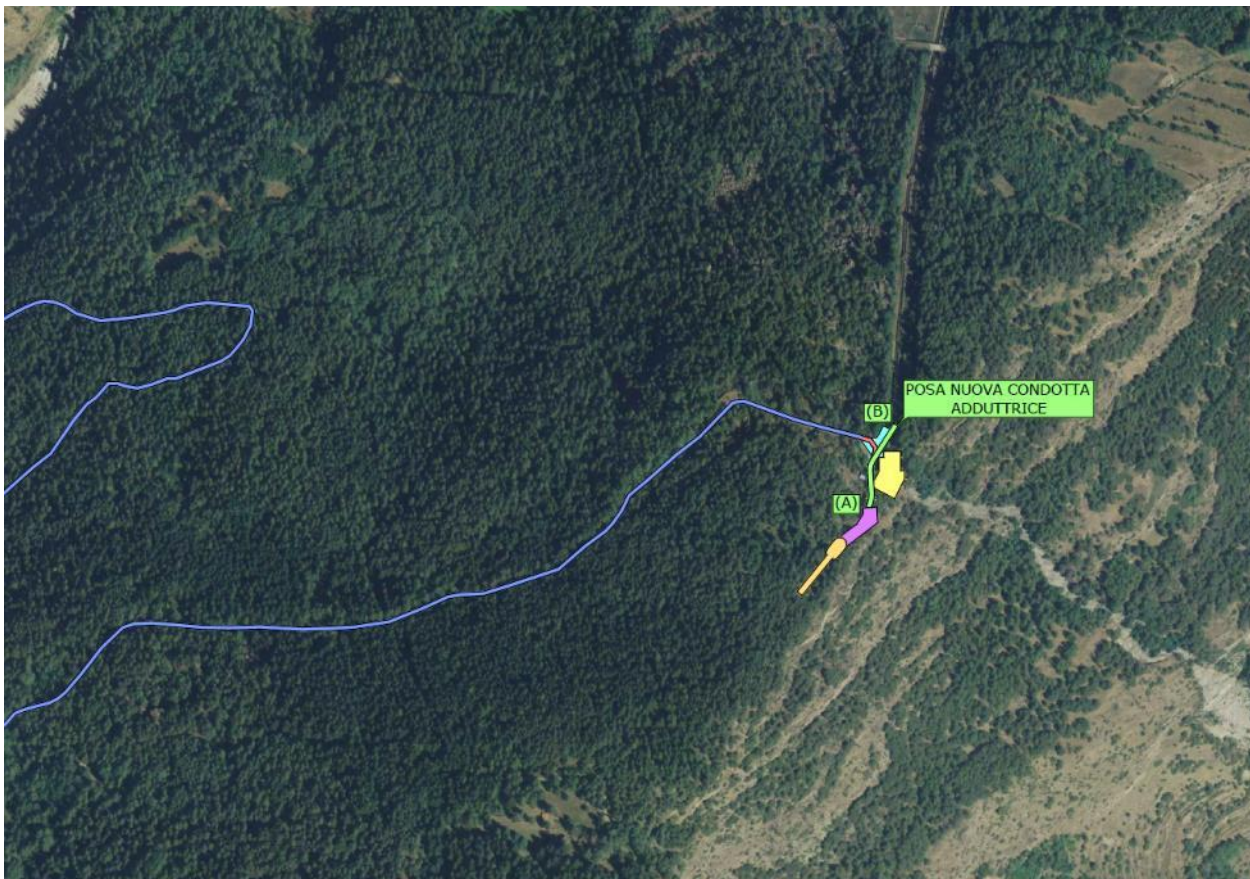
Lotto II B cantiere D fase III realizzazione primo tratto di condotta forzata
